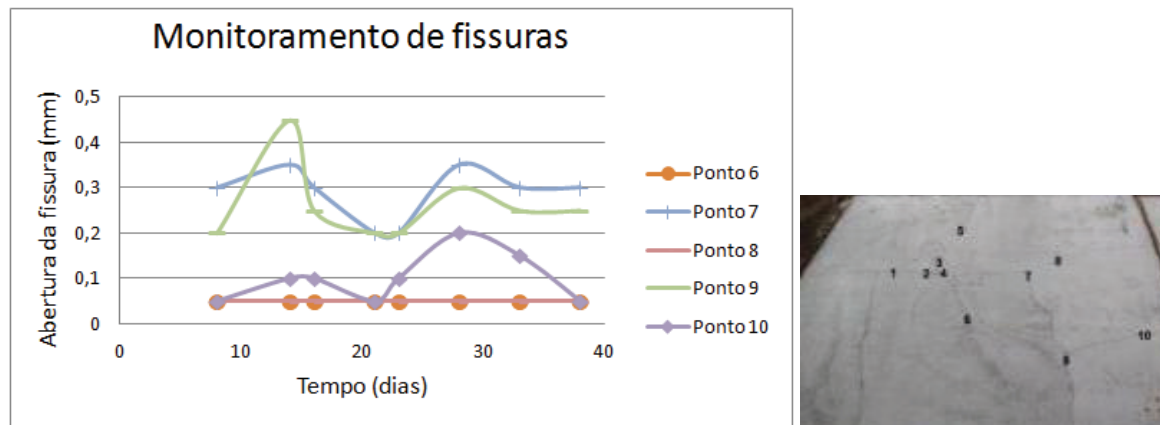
Monitoramento de fissuras (pontos de 6 a 10).
